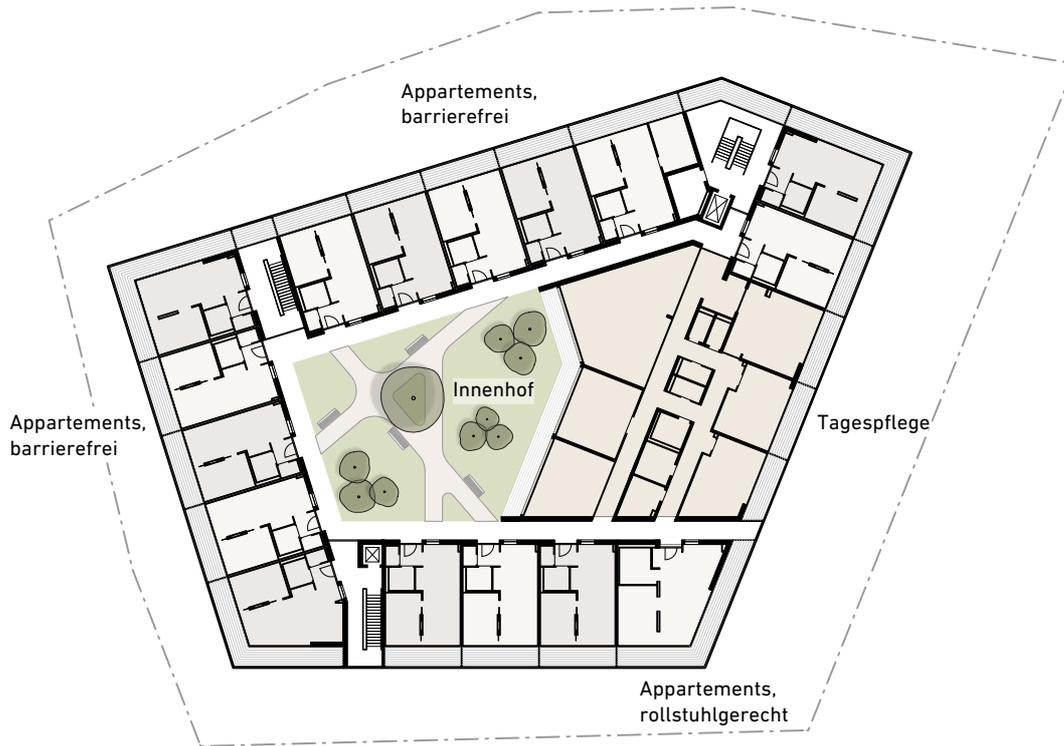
Das Vorhaben - Grundriss 2.Obergeschoss (Vorentwurf)
